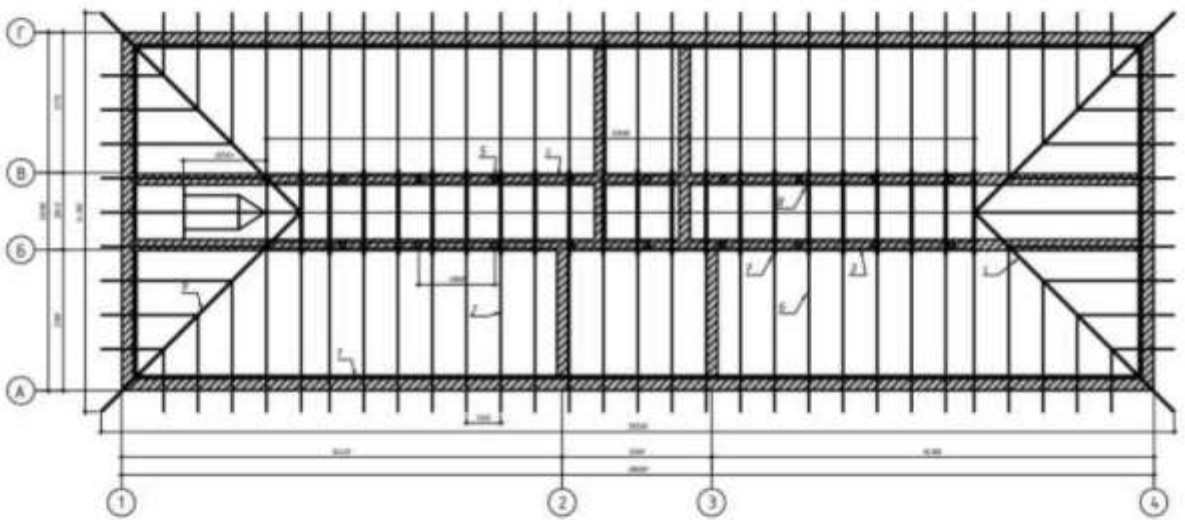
План кроквяної системи обстежуваної будівлі
